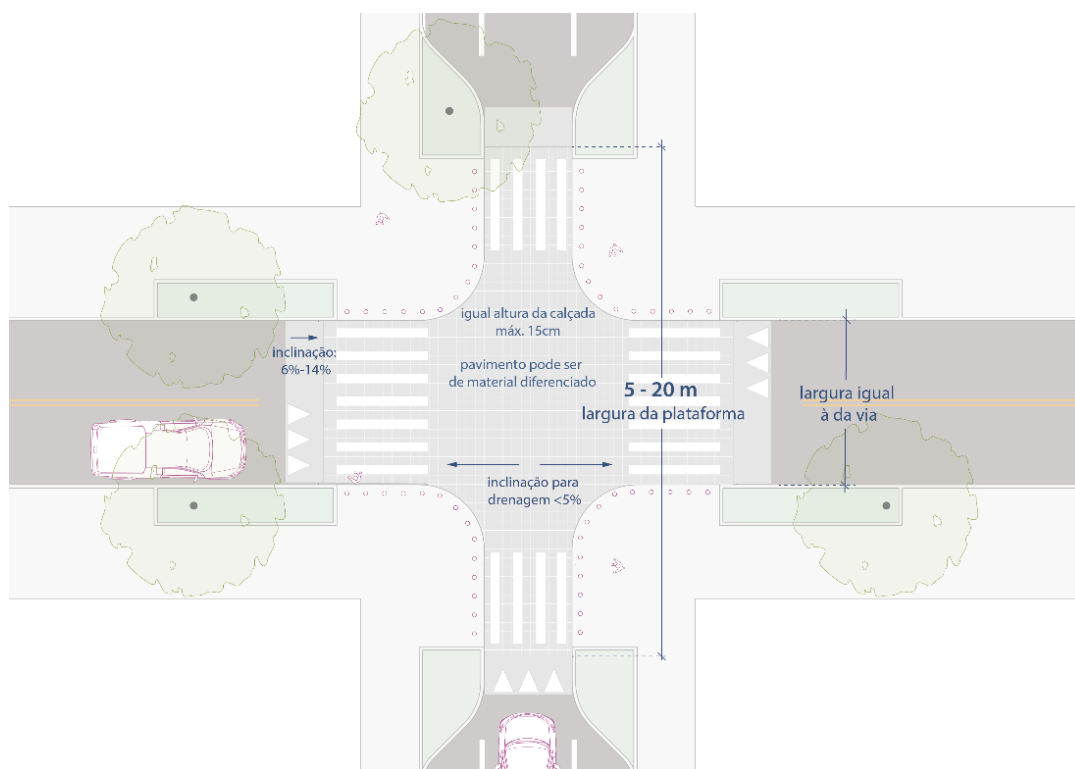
Dimensionamento de interseções elevadas em planta. Fonte: Elaboração dos autores com base em rampas de Faixa elevada para travessia de pedestres.
